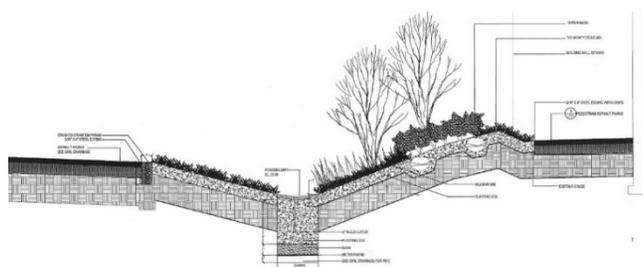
Propuesta de sistema de drenaje en zanja en Harvard University, Cambridge, Massachusetts
